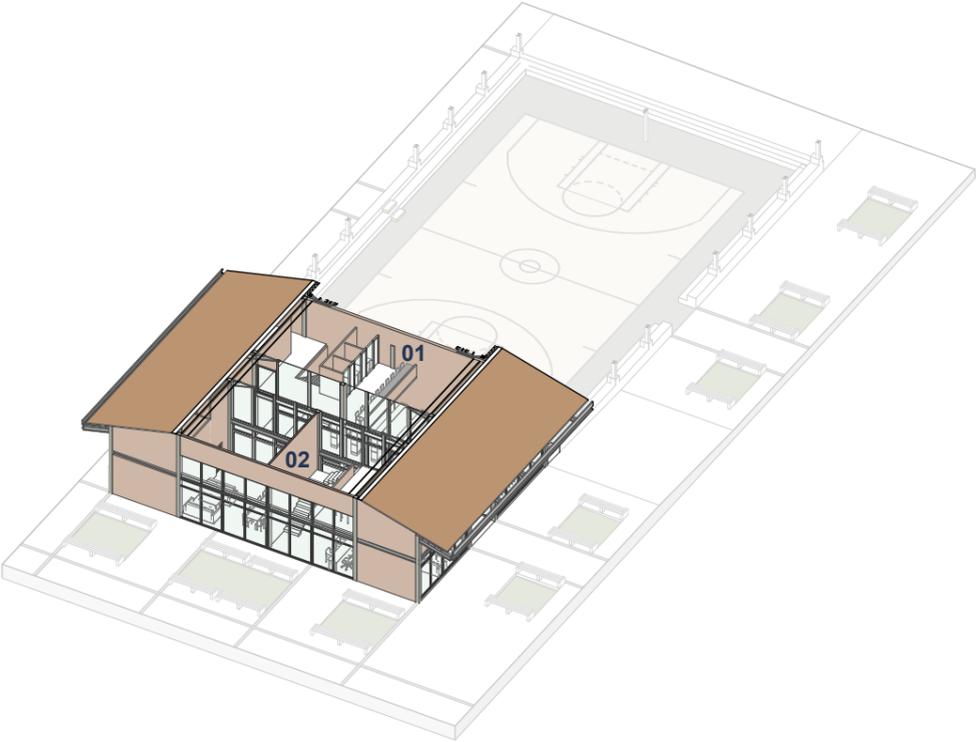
Administración, planta baja. Fuente: Elaboración propia, 2025.
